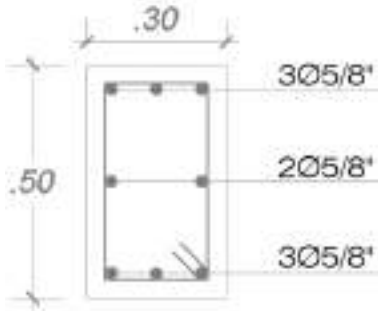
Disposición del acero de refuerzo inicial en la columna C-1
